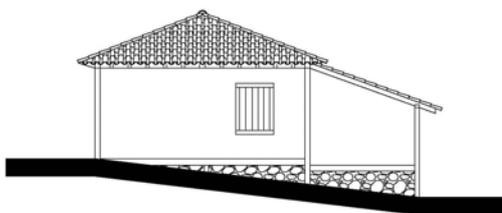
Fachada Oeste (Acervo PROAU/FAU/UnB).
